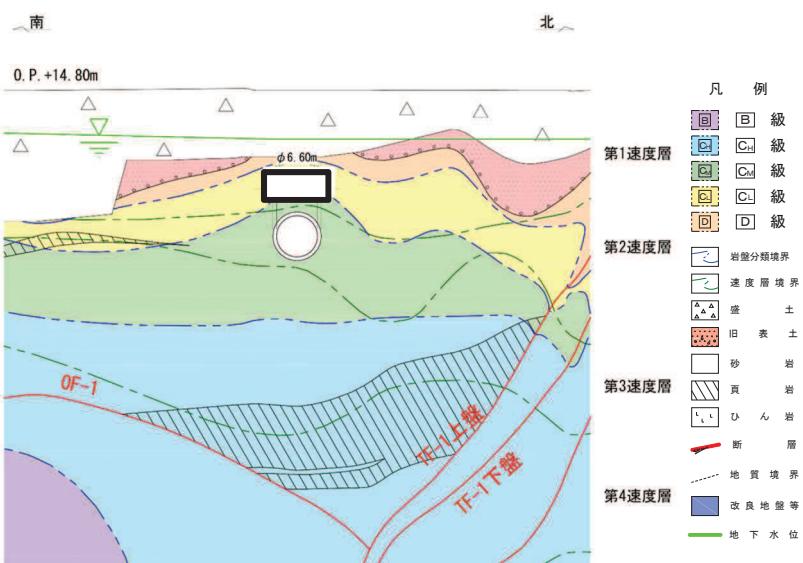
排気筒連絡ダクト（岩盤部）評価対象断面図（断面⑤）
